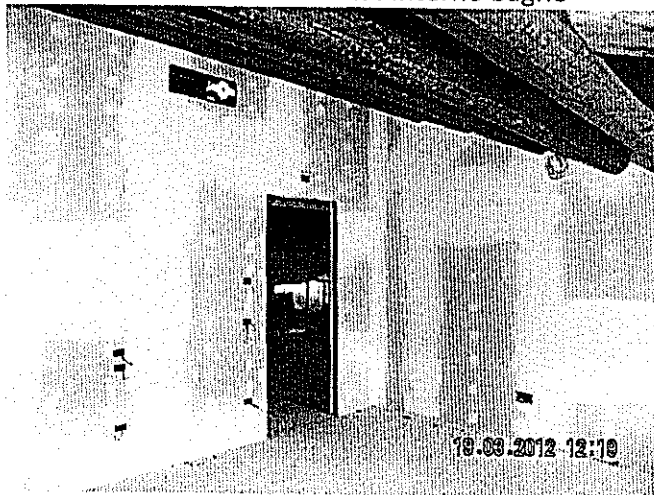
Stanza 2.4: Vista parete interna con porta ingresso
